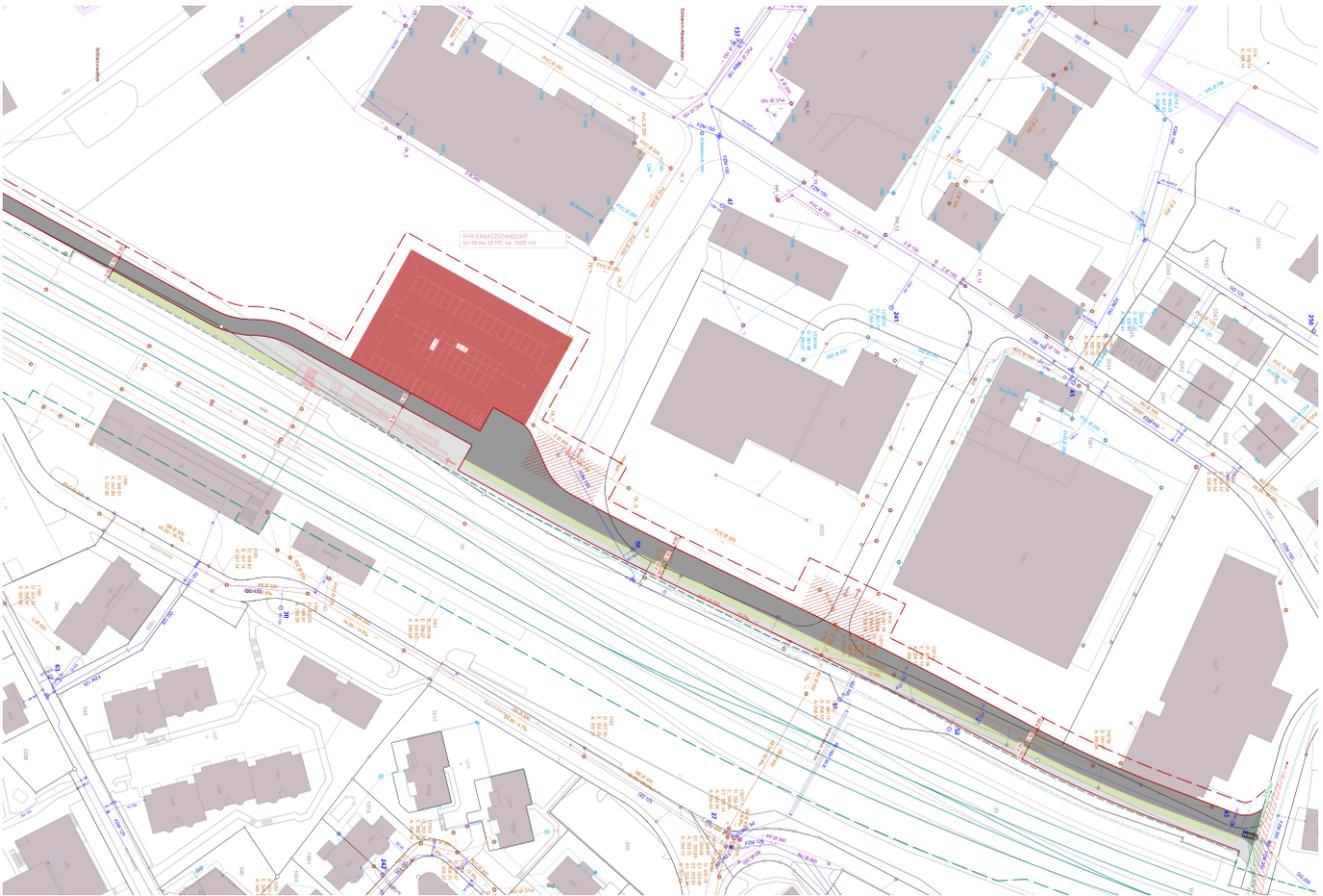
Erschliessungsplan mit bestehenden Werkleitungen
